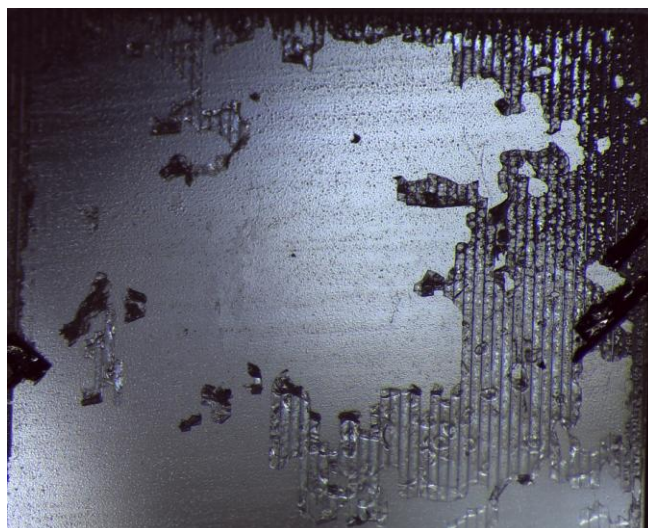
Superfície de fractura do prisma, amostra Pul2.
